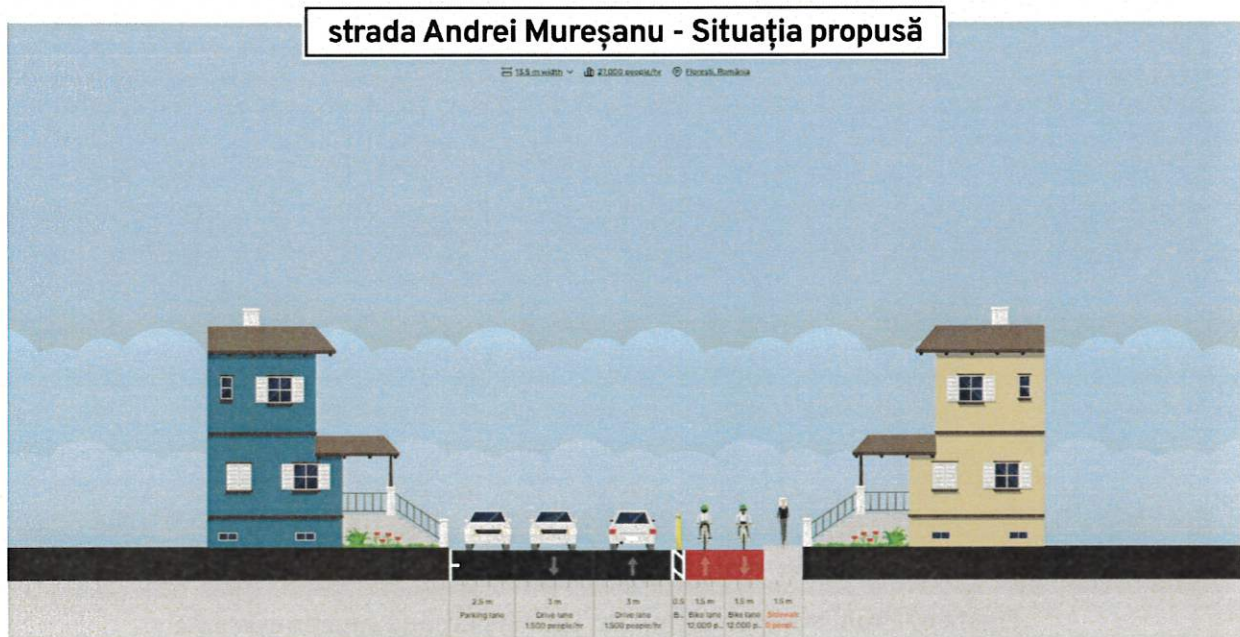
Profil transversal tip - Str. Andrei Mureșanu situație propusă
